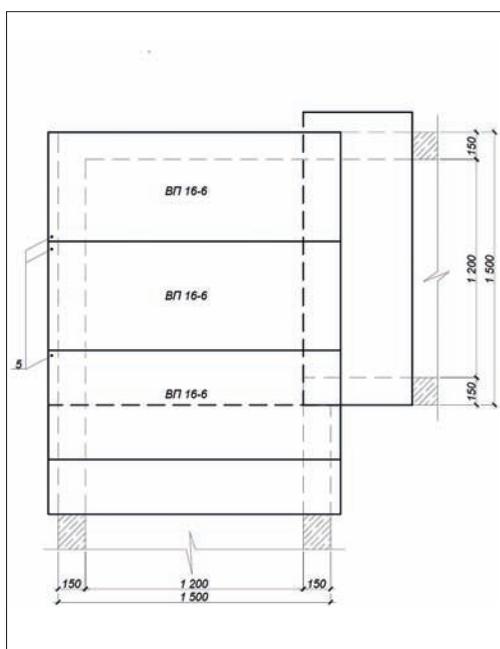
Фрагмент схемы раскладки плит перекрытия
